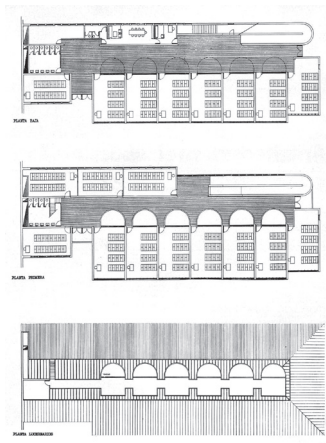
Escuela Elvira España, Tudela. Planta baja, planta primera, "planta lucernarios".
